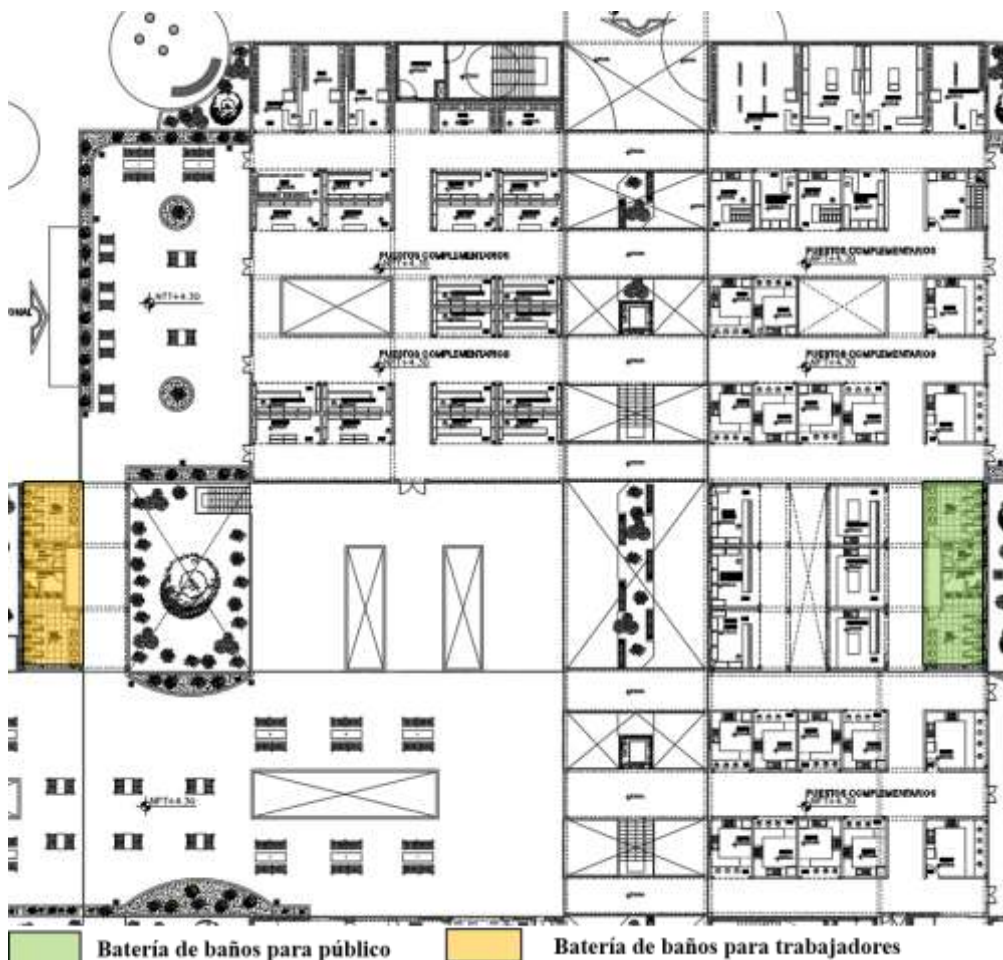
Batería de baños para público y trabajadores – Puestos de venta
